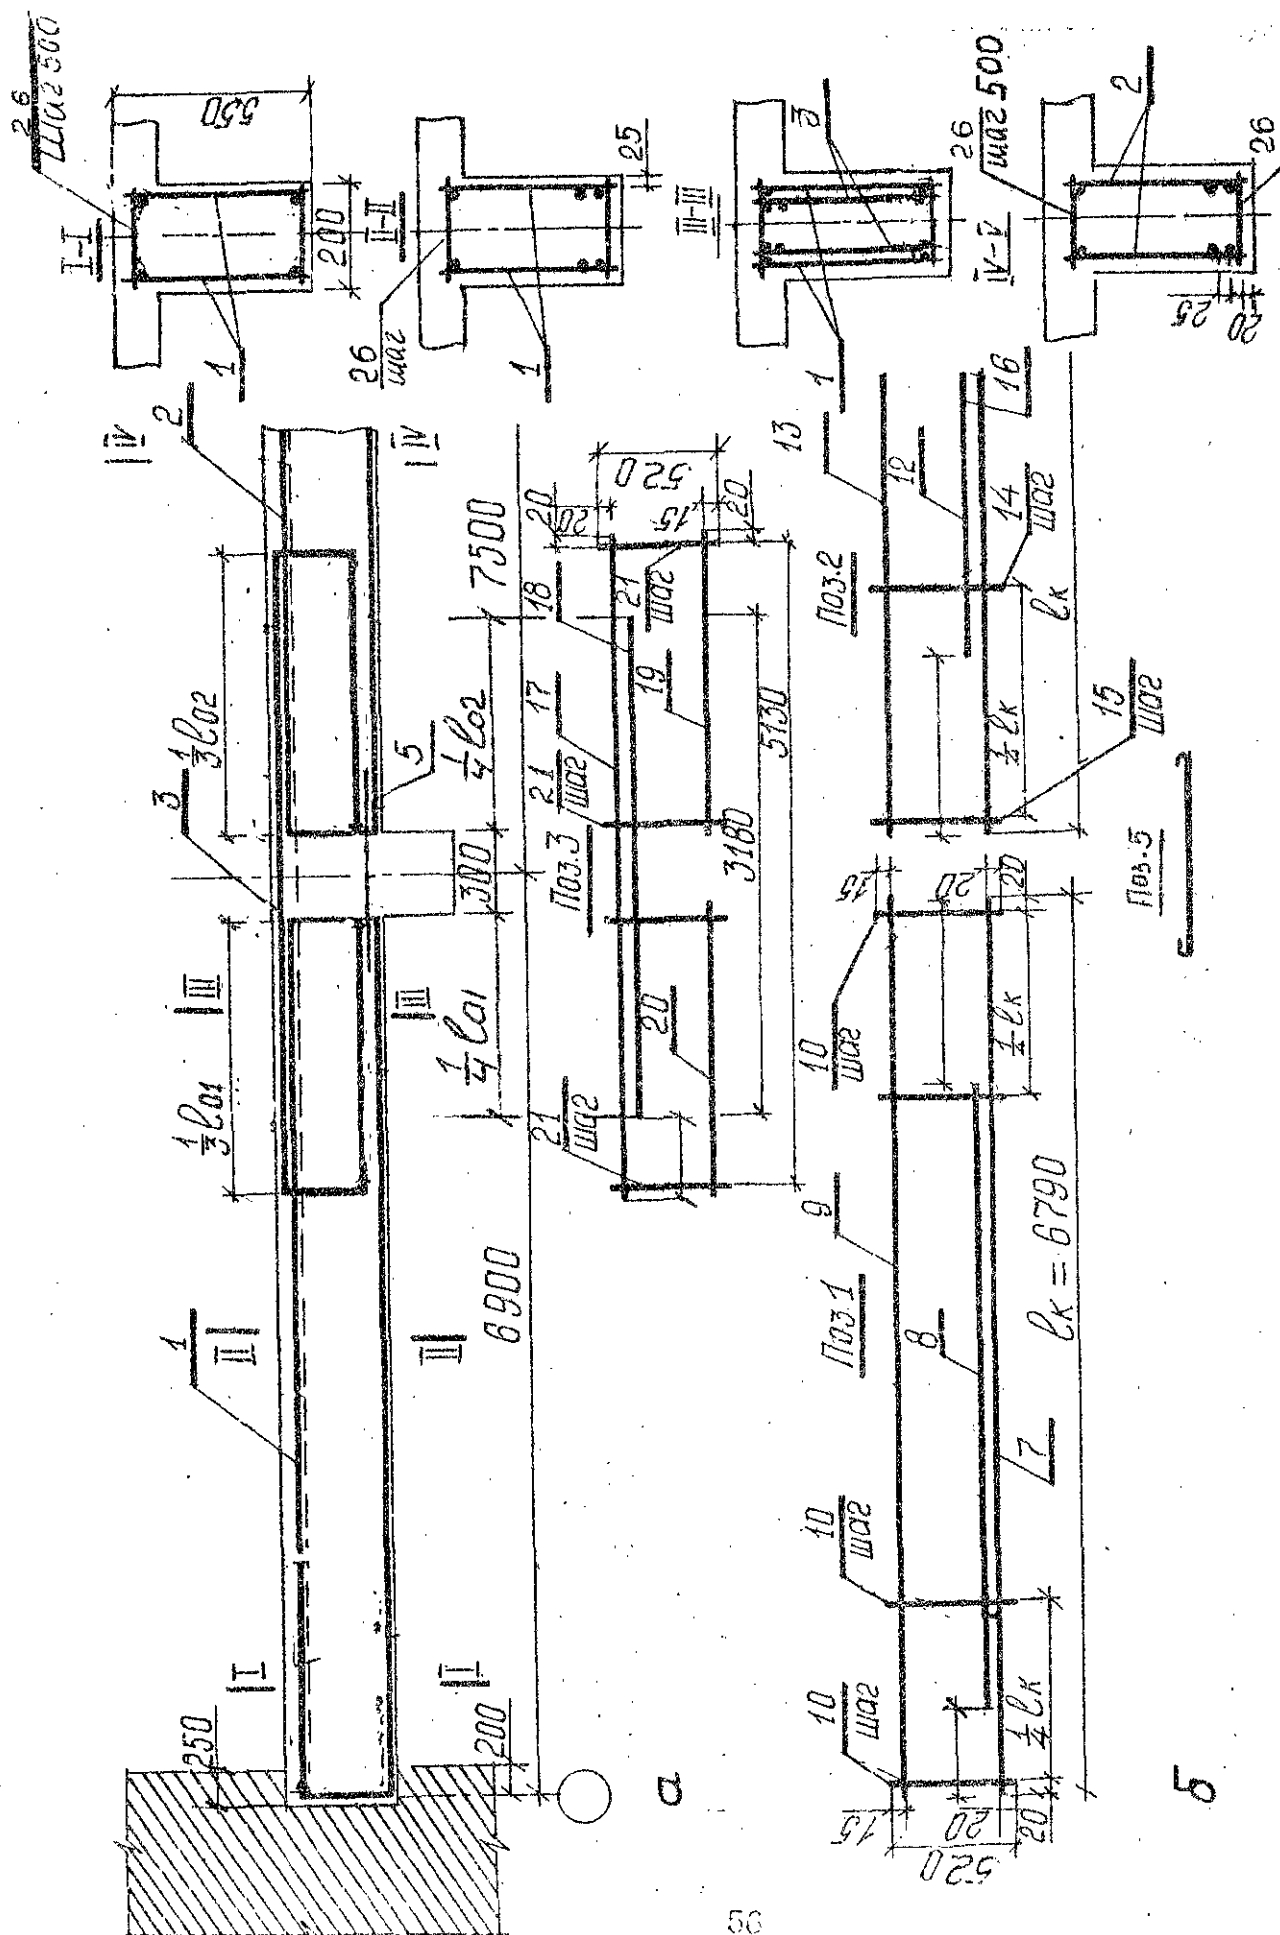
Армирование второстепенной балки сварными каркасами в пролетах и над опорами:
